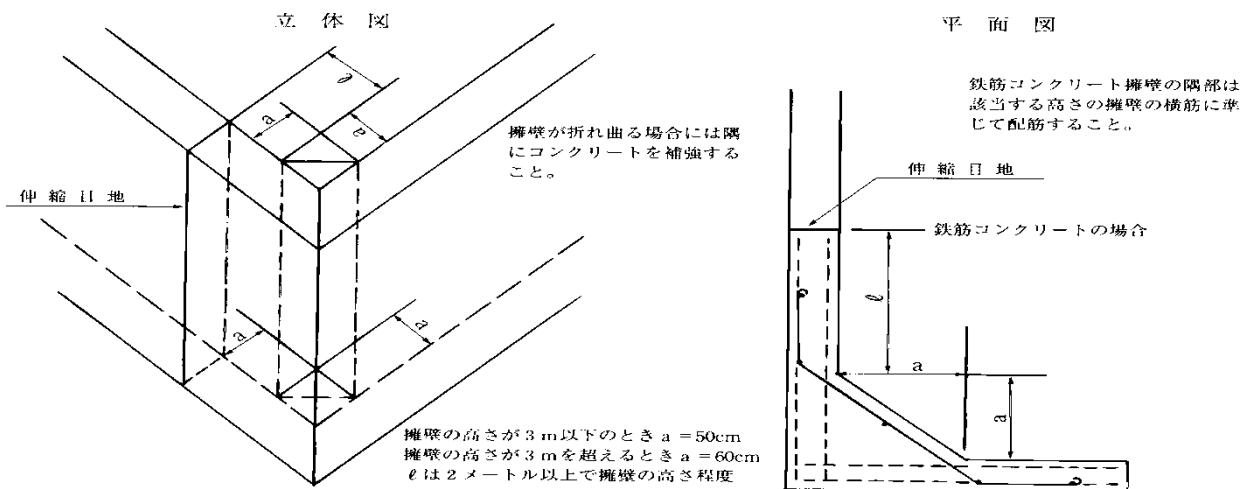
擁壁の隅角部の補強図（鉄筋コンクリート造等擁壁）
